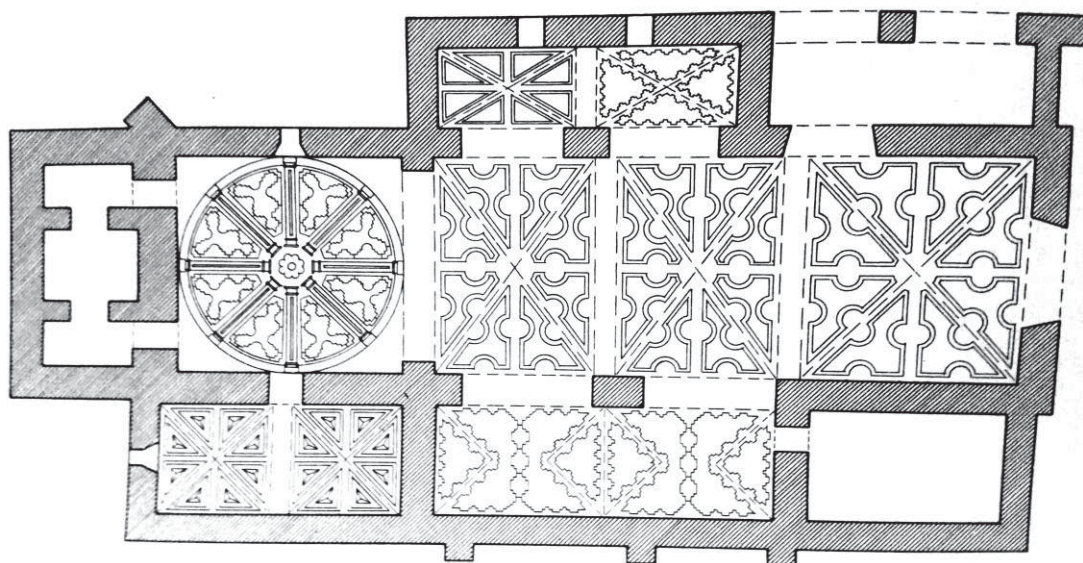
planta de la ermita de Castrillo Tejeriego (fuente: ZALAMA RODRÍGUEZ, M. A., *Eremitas y santuarios...*, p. 66)
